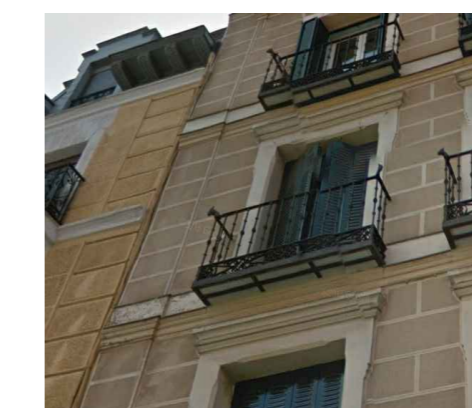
APLACADO DE PIEDRA CALIZA COLOR CREMA CLARO Y AMARILLO
